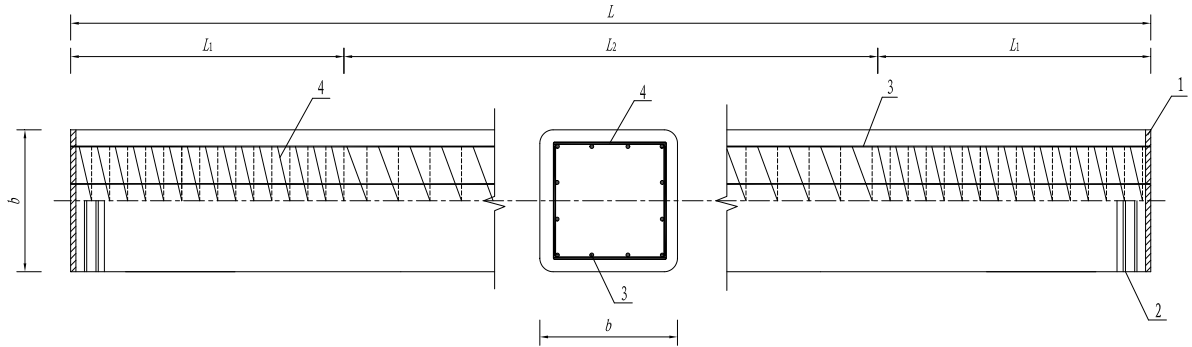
2-1 预应力混凝土实心方桩、预应力高强混凝土实心方桩结构形式图
